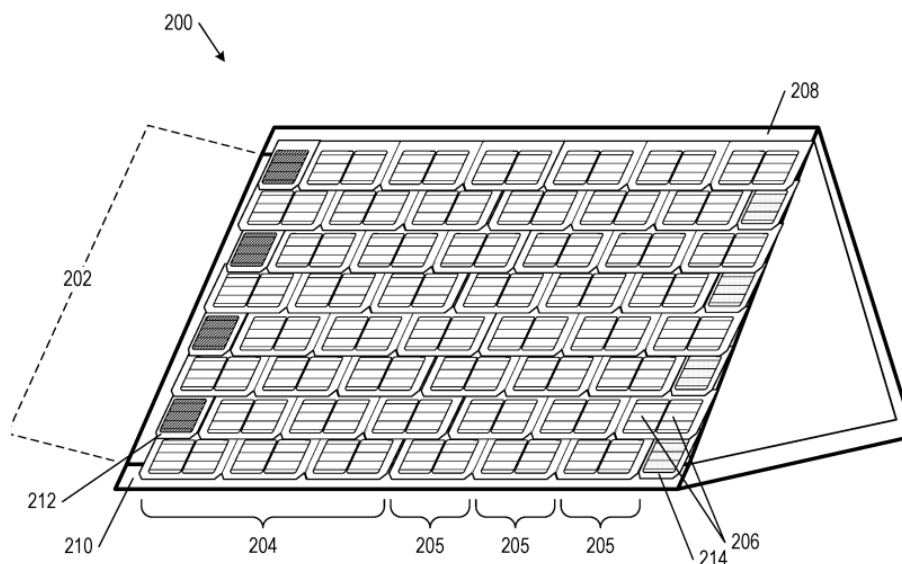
Planta esquemática completa de integração do telhado – Sistema BIPV
